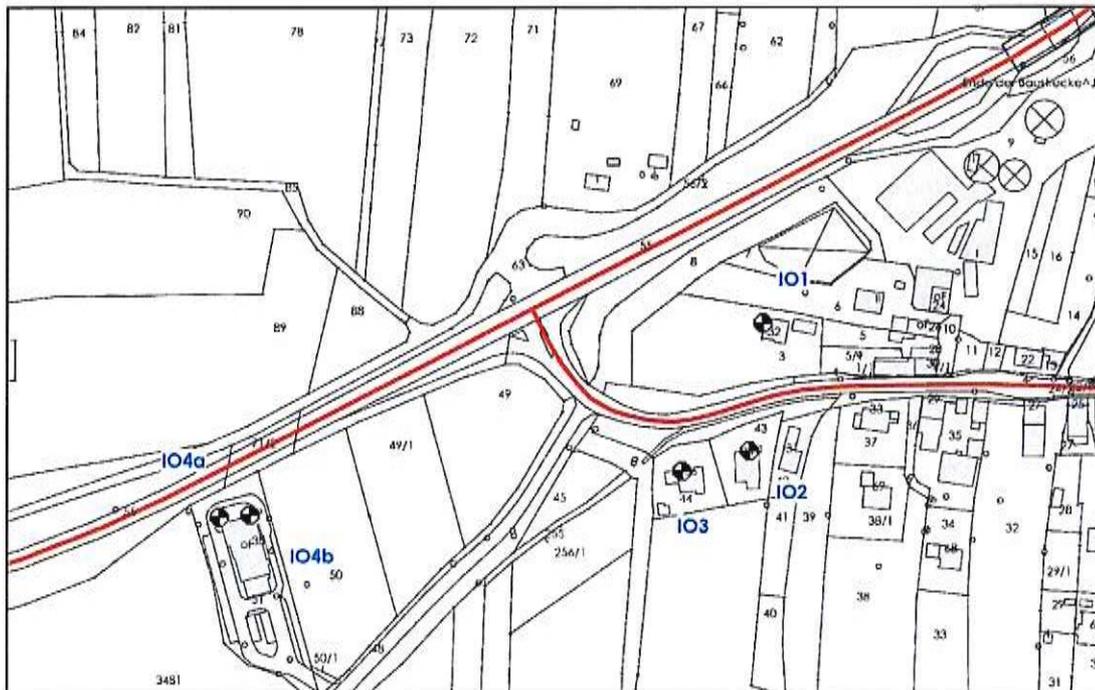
Lageplan mit Eintragung der maßgeblichen Immissionsorte
